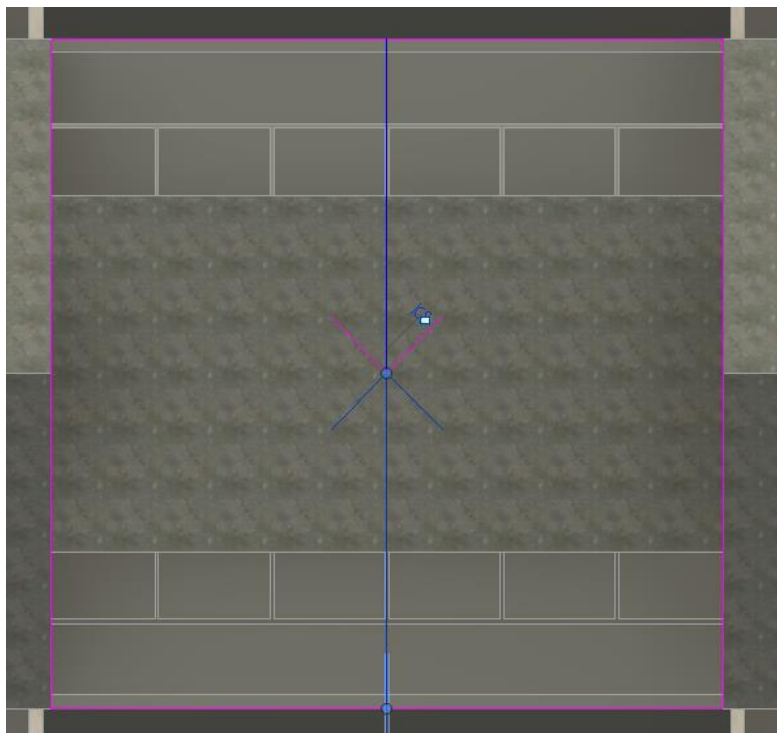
Diseño de las primeras cubiertas, o las cubiertas más bajas del edificio
